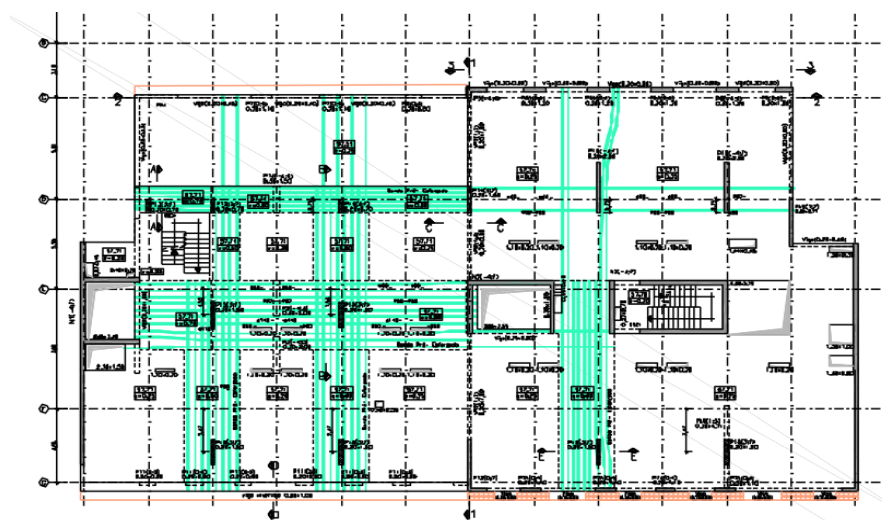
| Planta do piso 3 laje de transição (a verde os cabos de pré-esforço)
